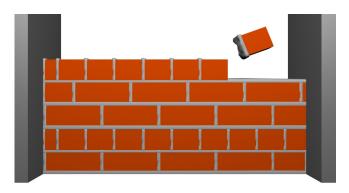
Aparejo Inglés Fuentes: Elaboración propia
